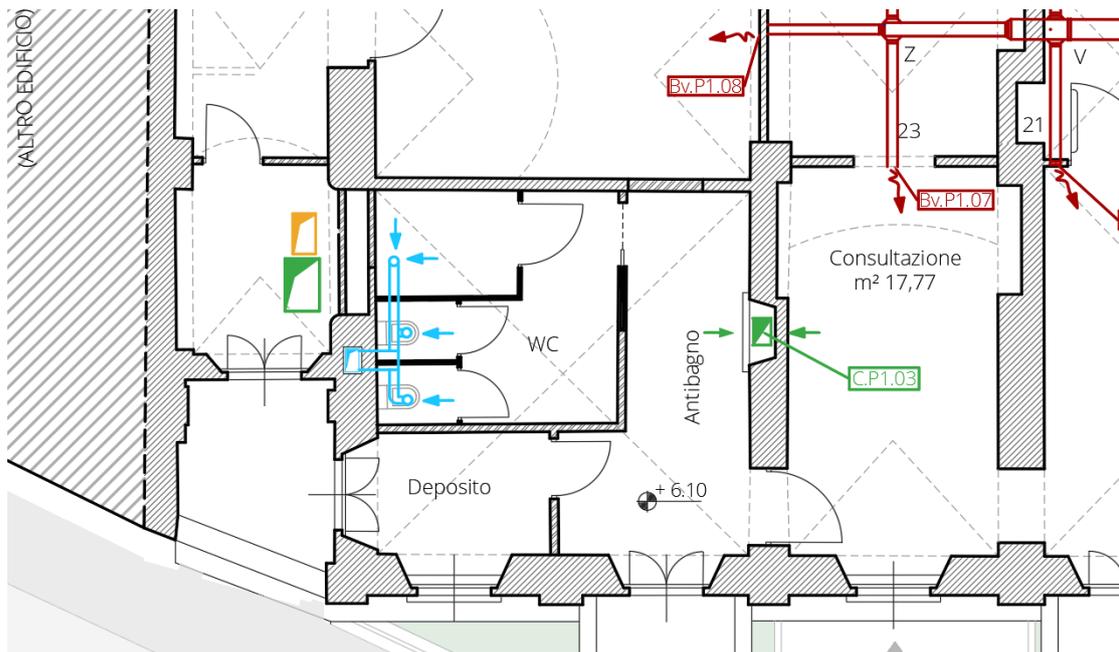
Estratto della pianta del piano 1 che riporta il sistema di aspirazione dei servizi igienici.
